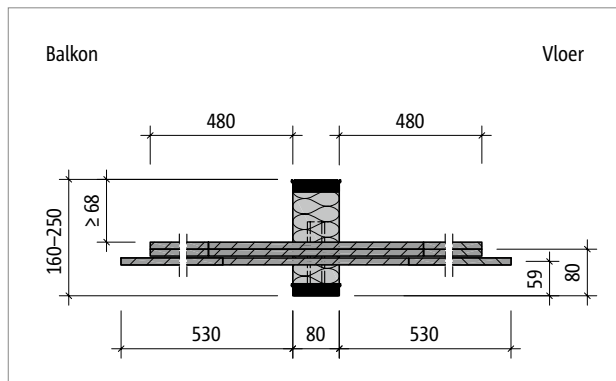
Schöck Isokorf® T type H-VV1-NN1: Bovenaanzicht
